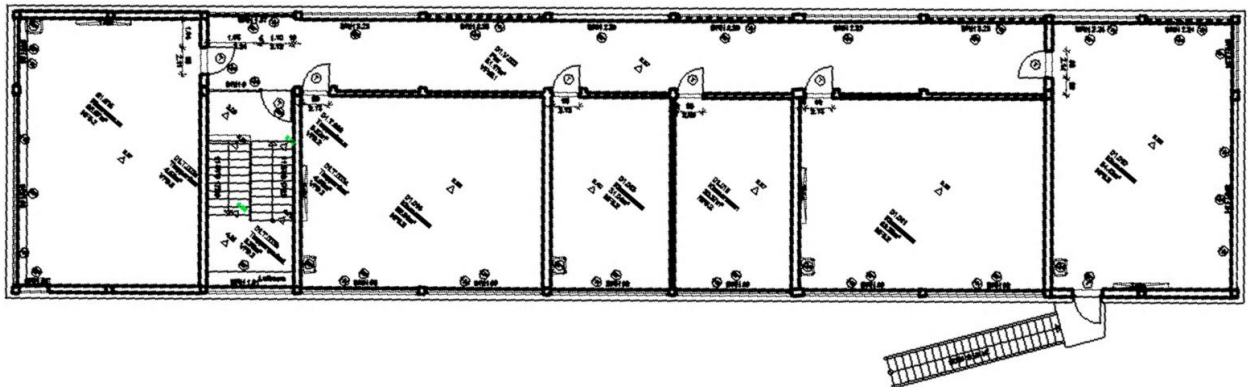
Ausschnitt 1. OG Grundriss Schulgebäude Trakt D
